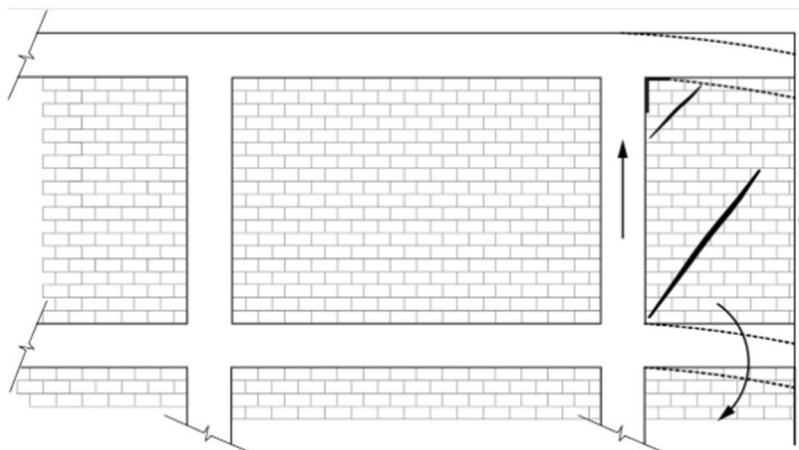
Fissura desenvolvida pela deformação dos elementos estruturais, com a maior deformação do elemento superior.
